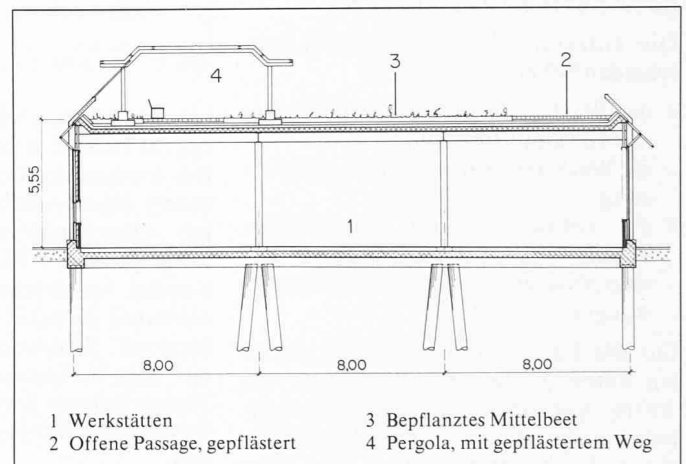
Querschnitt Betriebsgebäude, mit Dachgarten
